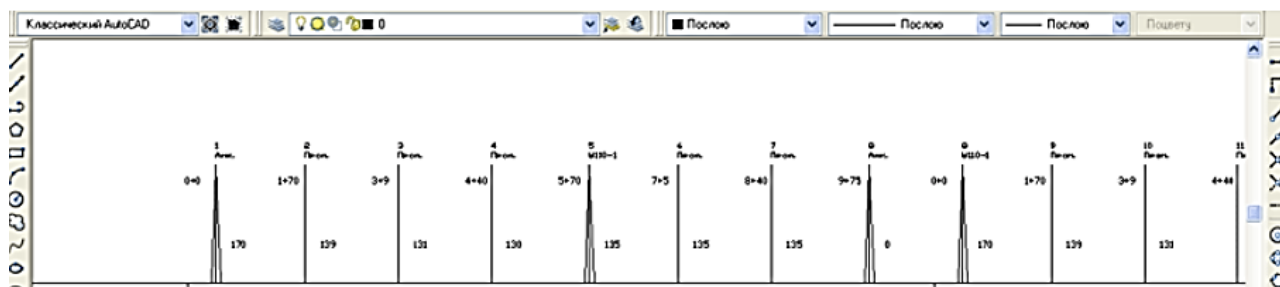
Фрагмент схемы прокладки оптического кабеля по опорам
